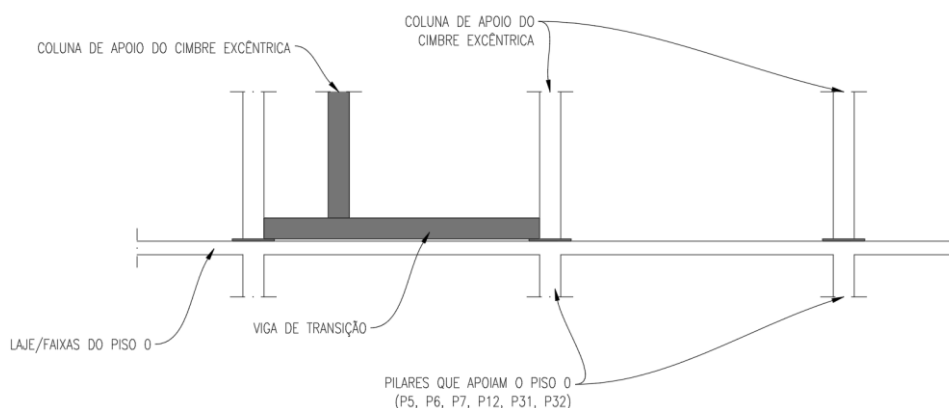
Esquema de genérico de vigas de transição para apoios do cimbramento excêntricos
